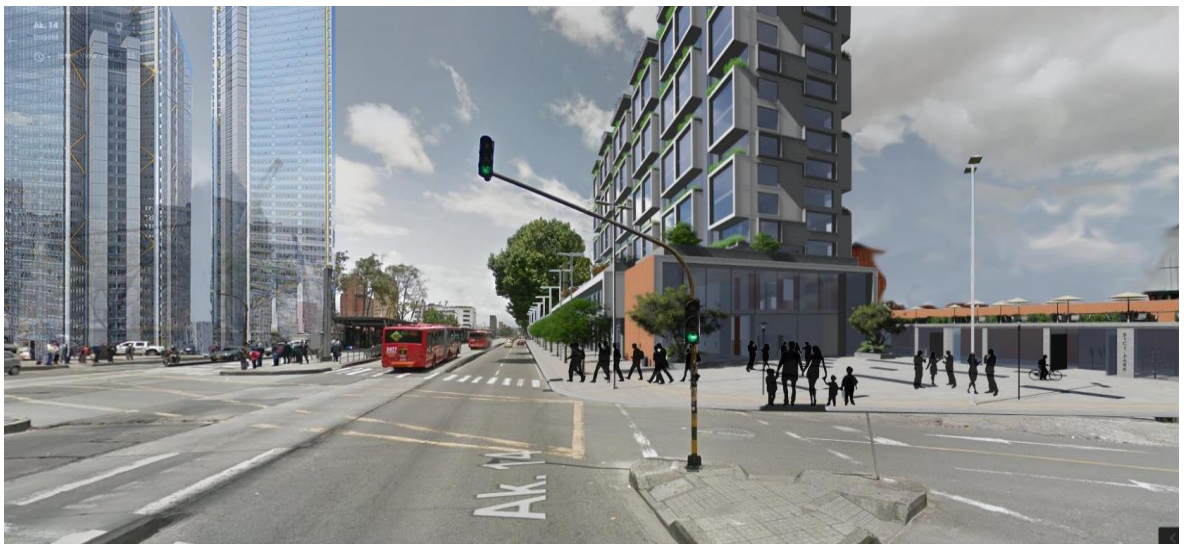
Alzado norte proyecto Urbano - Arquitectónico
